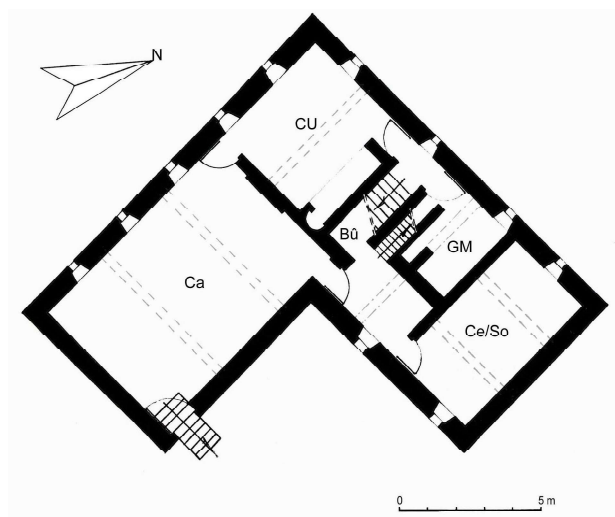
Jouveaux. Plan restitué du sous-sol vers 1590.
